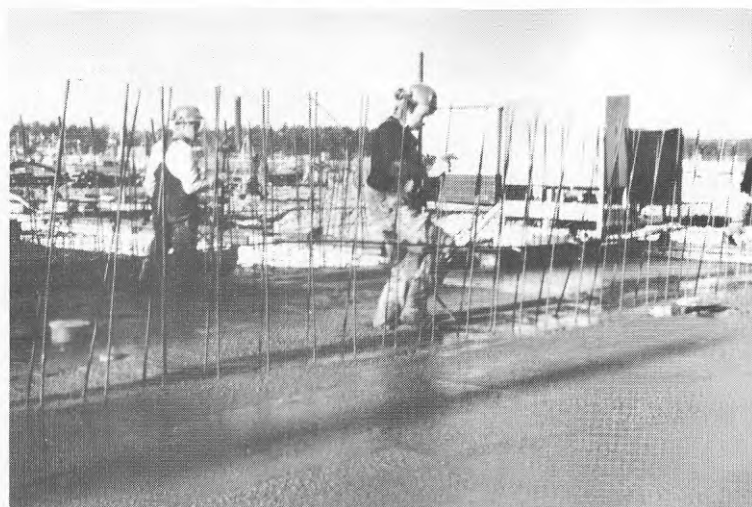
Exempel på betongyta endast avjämnad med betongraka
